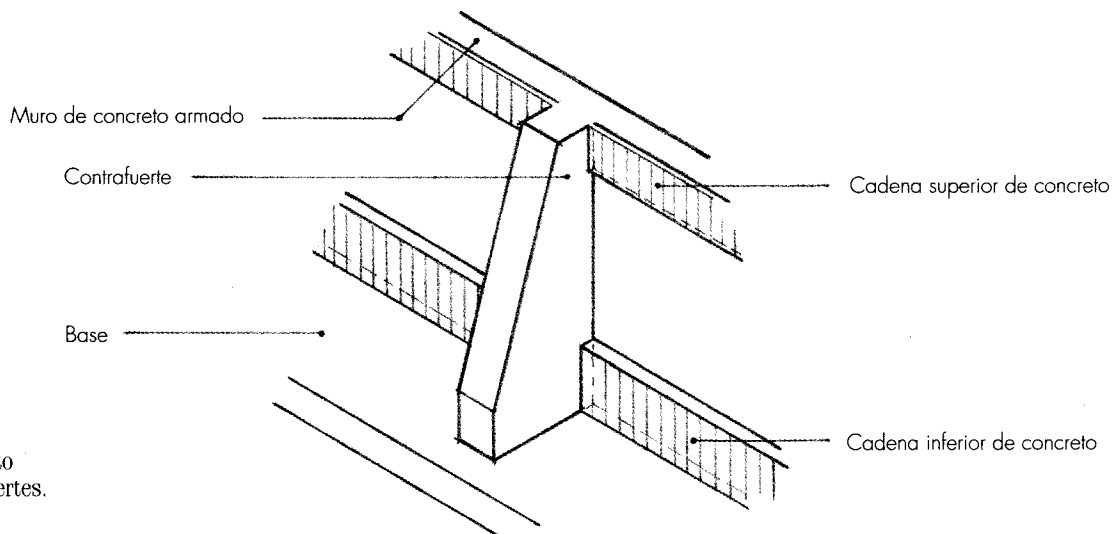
Muro de contención de concreto armado con contrafuertes.
